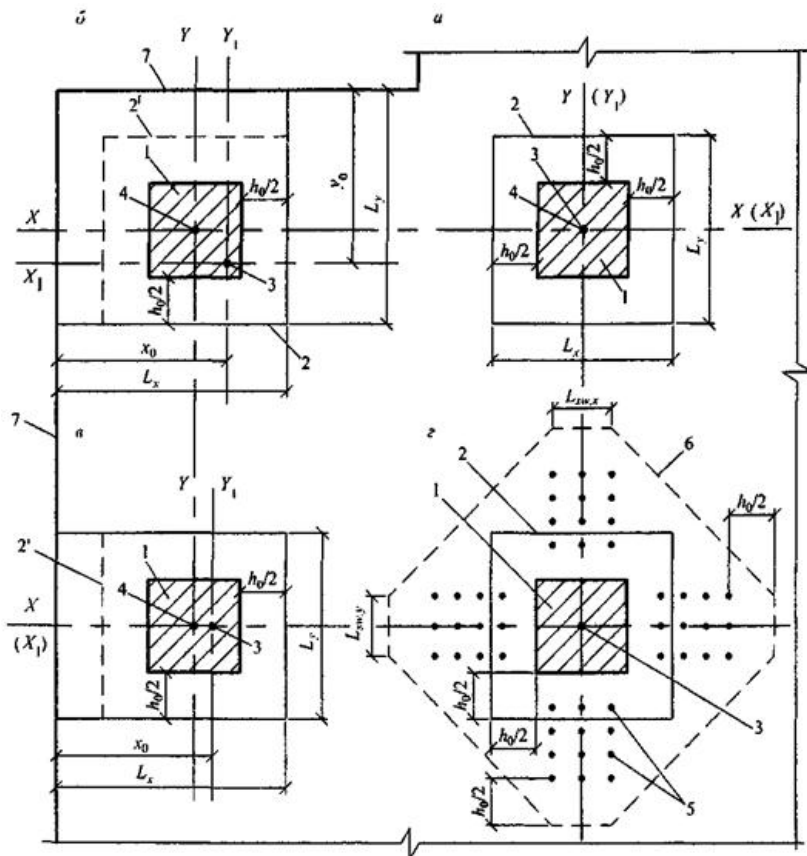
Схема расчетных контуров поперечного сечения при продавливании: *а* – площадка приложения нагрузки внутри плоского элемента; *б, в* – то же у края плоского элемента, *з* – при крестообразном расположении поперечной арматуры; 1 – площадь приложения нагрузки; 2 – расчетный контур поперечного сечения; 2' – второй вариант расположения расчетного контура; 3 – центр тяжести расчетного контура (место пересечения осей X_1 и Y_1); 4 – центр тяжести площадки приложения нагрузки (место пересечения осей X и Y); 5 – поперечная арматура; 6 – контур расчетного поперечного сечения без учета в расчете поперечной арматуры; 7 – граница (край) плоского элемента
